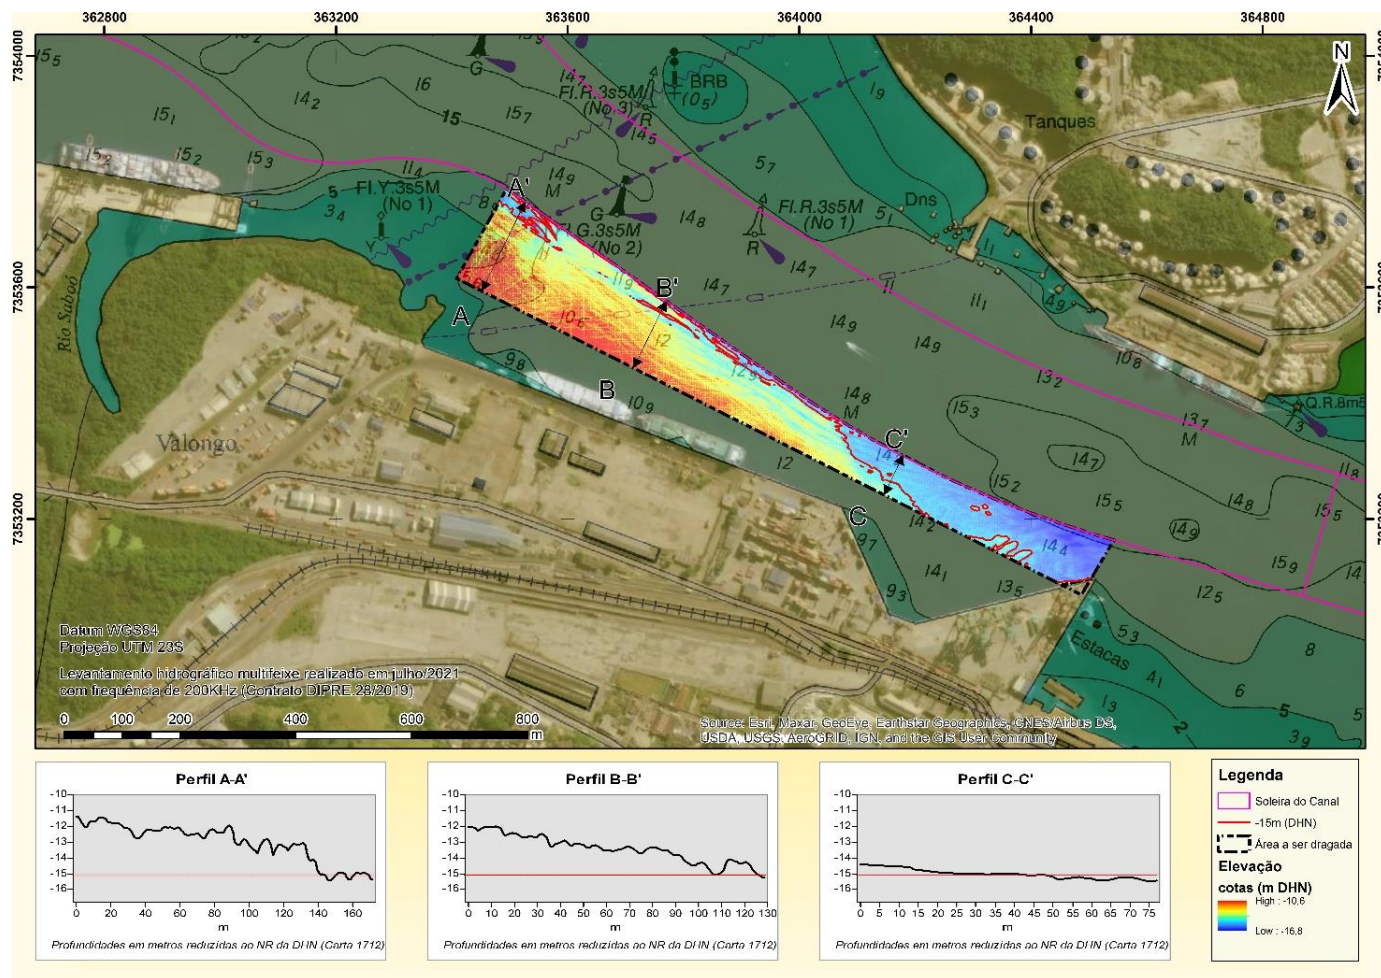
Área a ser dragada pelo futuro arrendatário, com detalhamento de perfis transversais
